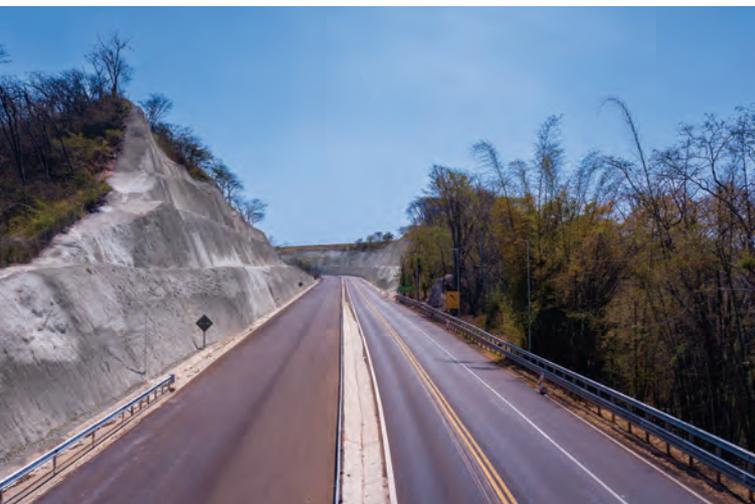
Outra vista do talude após a aplicação do concreto projetado.
